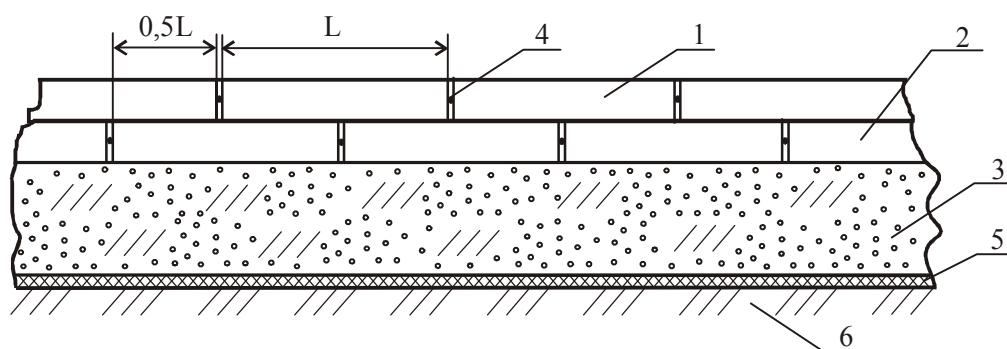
Двухслойное дорожное покрытие из железобетонных плит: 1 – плиты верхнего слоя, 2 – плиты нижнего слоя, 3 – песчаное основание плит, 4 – стыковые соединения, 5 – теплонит, 6 – земляное полотно, L – длина плиты
